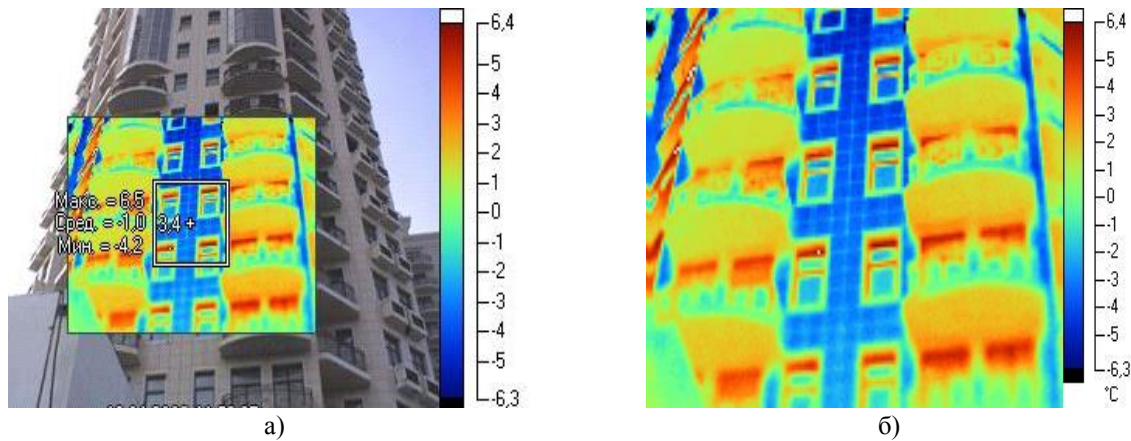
Жилое здание, утепленное по технологии вентилируемого фасада: а) фото фрагмента здания с областью обследования, б) термограмма
